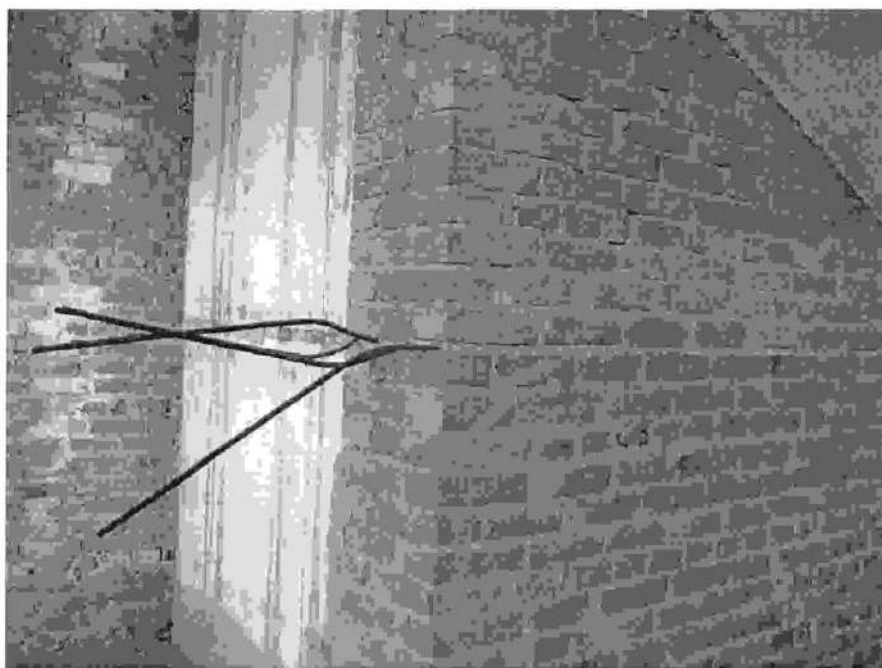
Самонесущая стена между лифтом и лестницей. Армопояс. 4 секция, 5 этаж. Состояние на 01.04.2015г
